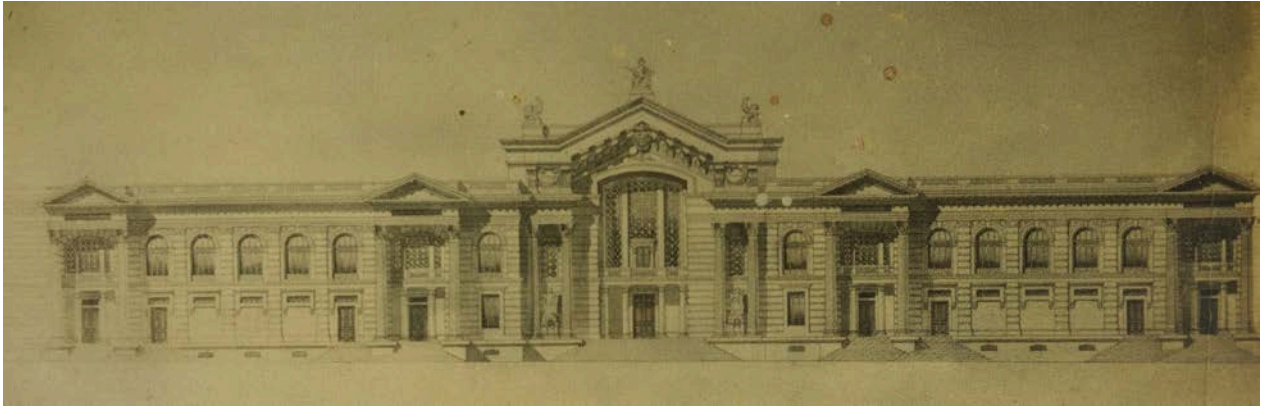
Proyecto de fachada Carrera 15 del Arquitecto Gastón Lelarge.
